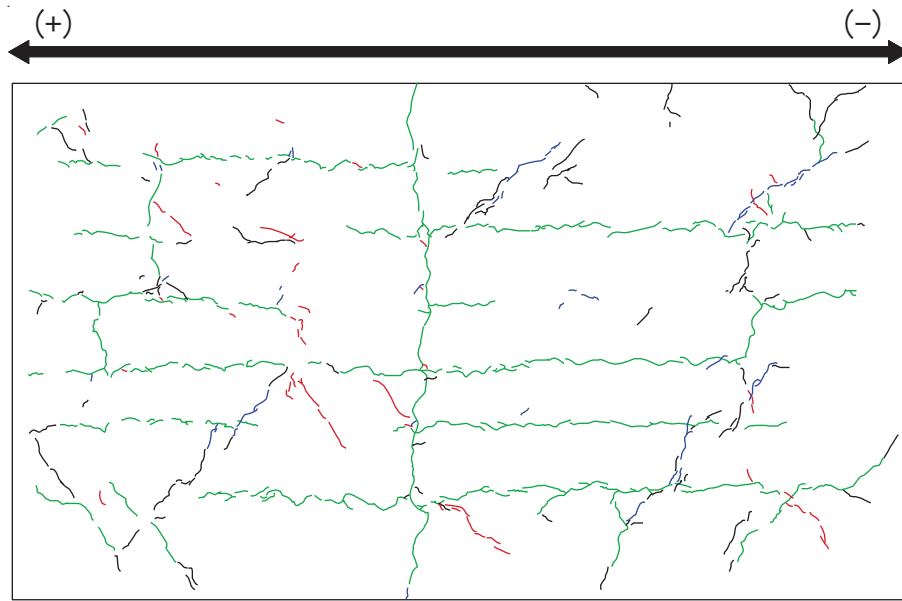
(5) 乾燥試験体 [1] 1/2500rad. におけるひび割れ図
